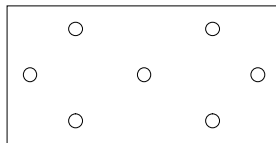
Plans de chevillage – panneaux de dimensions 1000 × 500 mm
